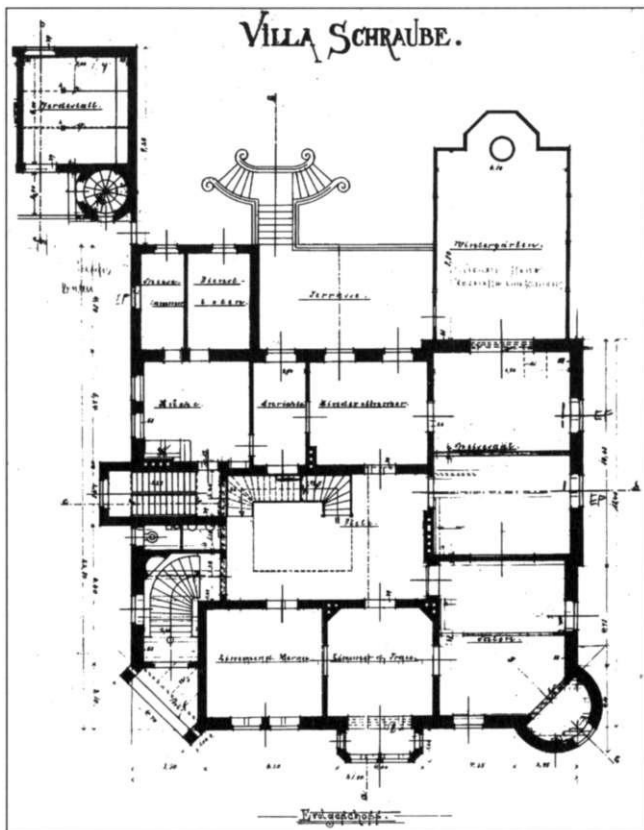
Maxim-Gorki-Straße 16, Grundriß des Wohnhauses ohne angrenzendes Stallgebäude, Erdgeschoß
